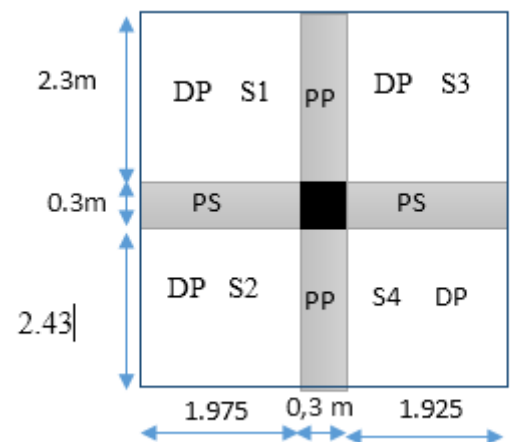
Surface qui revient au poteau A niveau sous-sol
